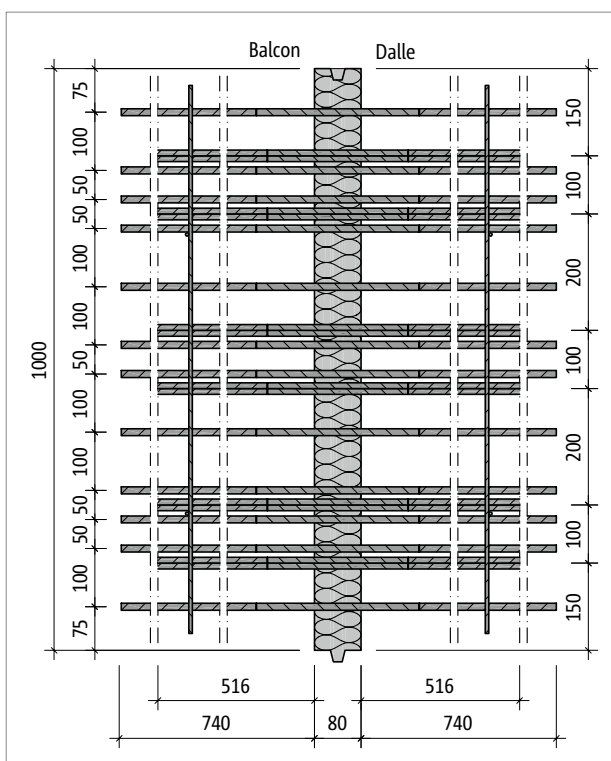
Schöck Rutherma® T type D-MM5-VV3 : vue en plan
